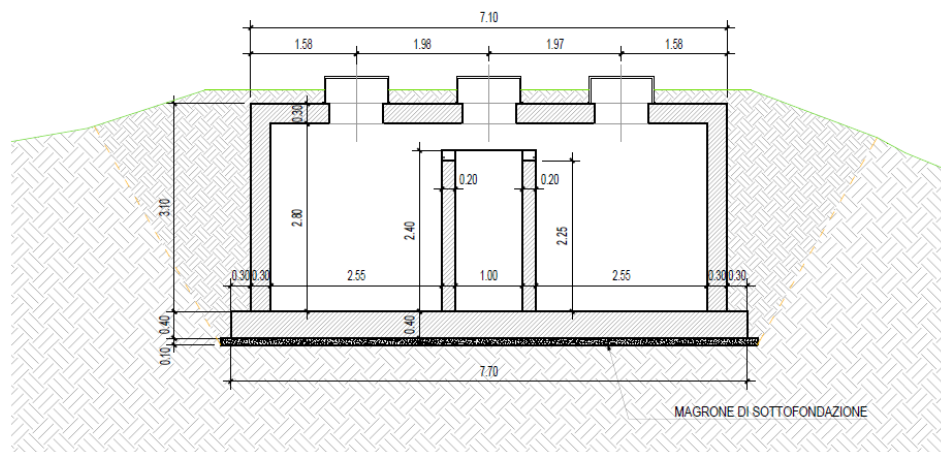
Sezione trasversale C – C' dell'edificio in progetto.
